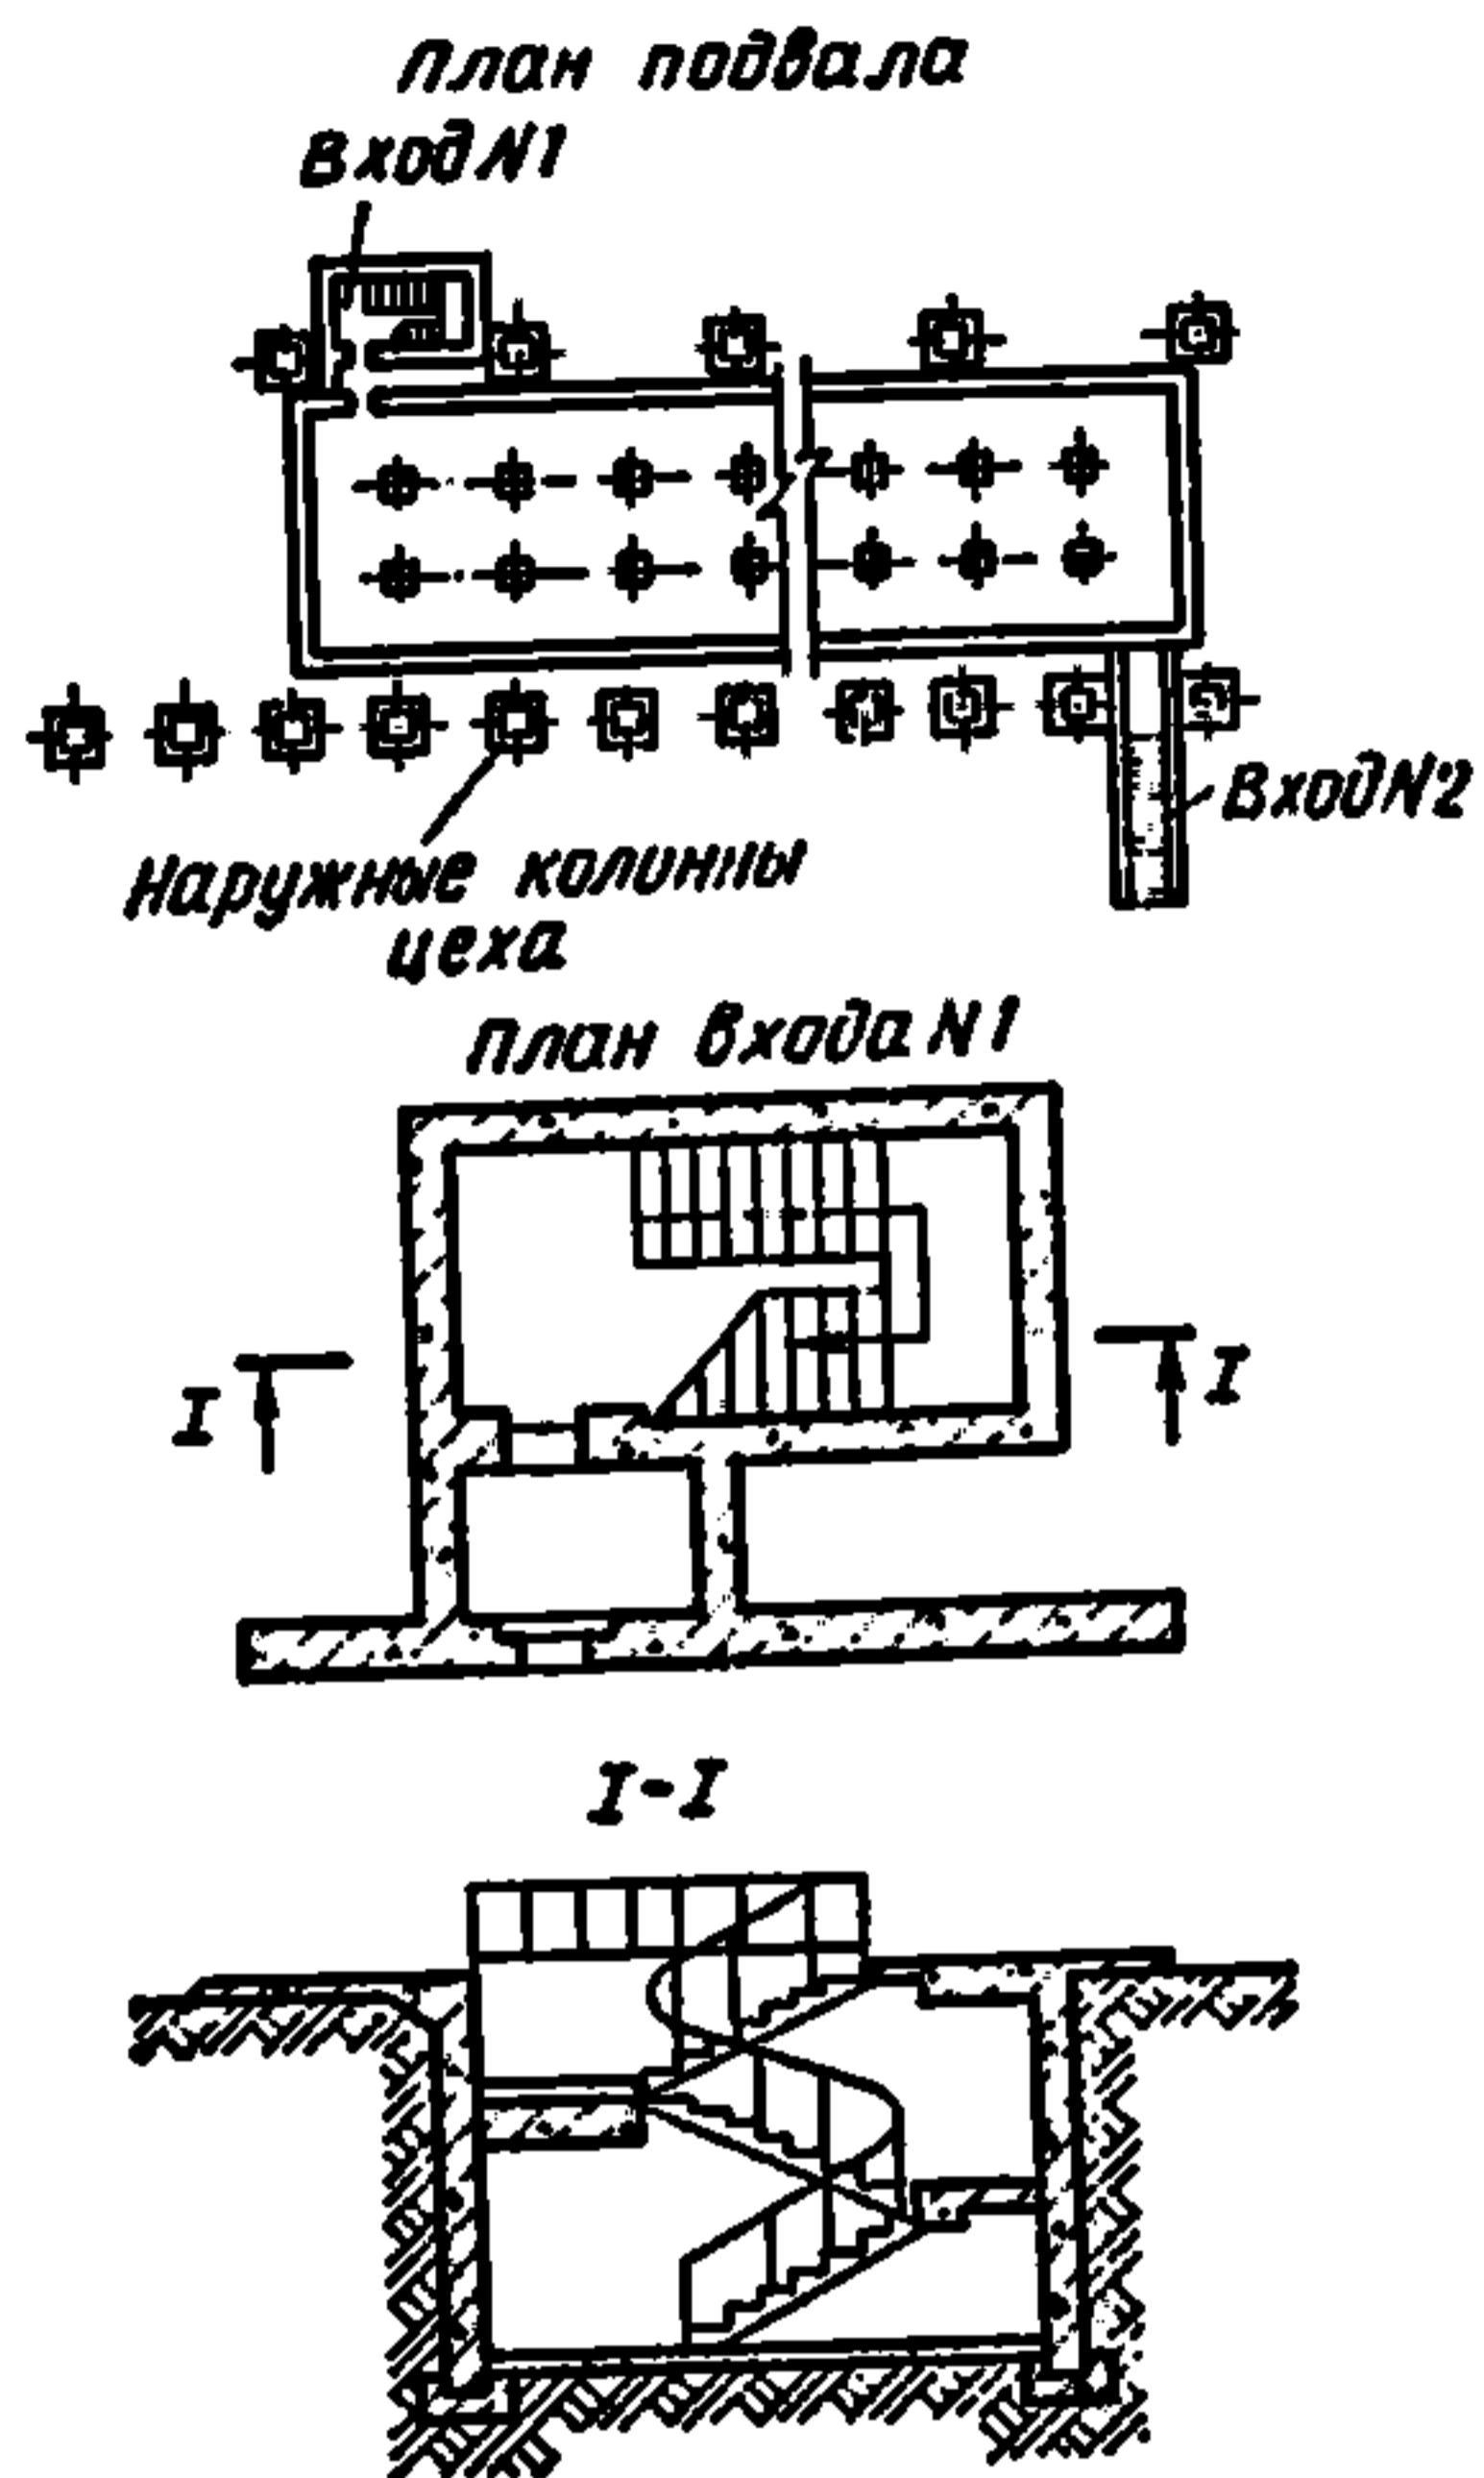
Вход в убежище из 1-го этажа производственного помещения
